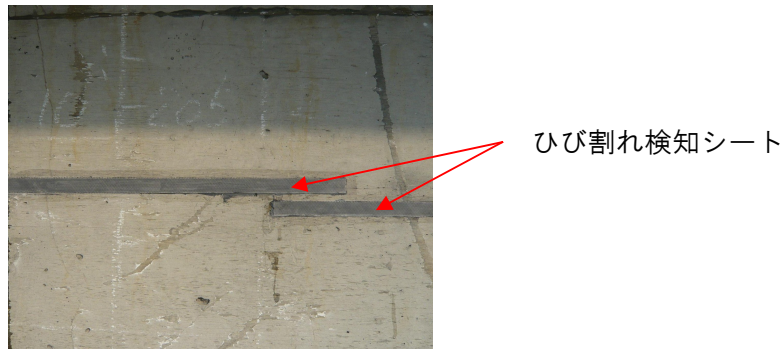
ひび割れ検知シート設置状況（ウェブ側面）
